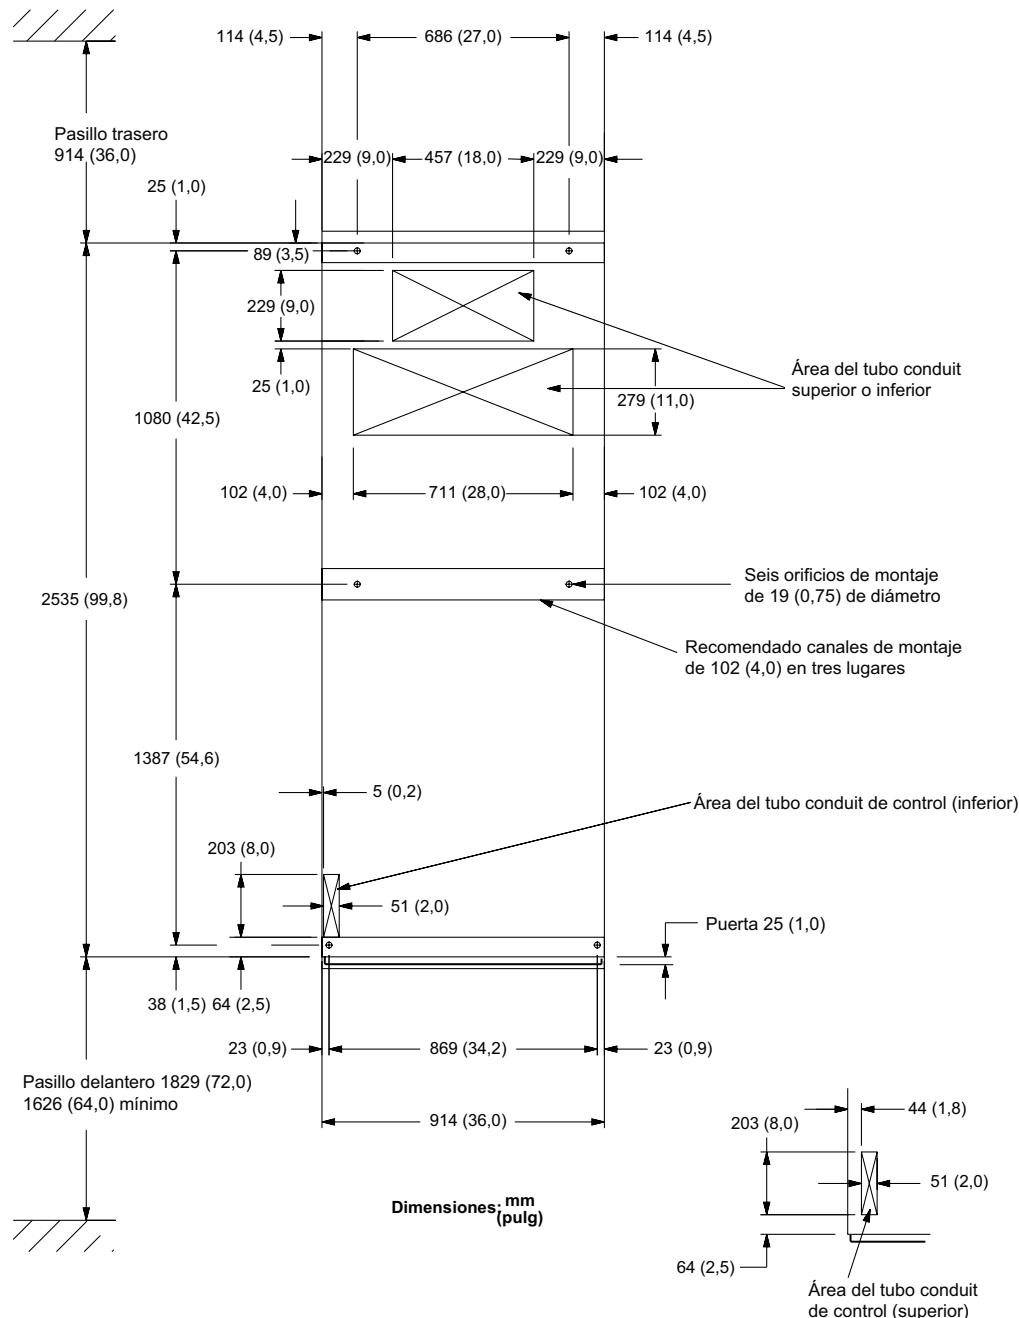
Plano de planta para tablero de fuerza de hasta 50 kA
